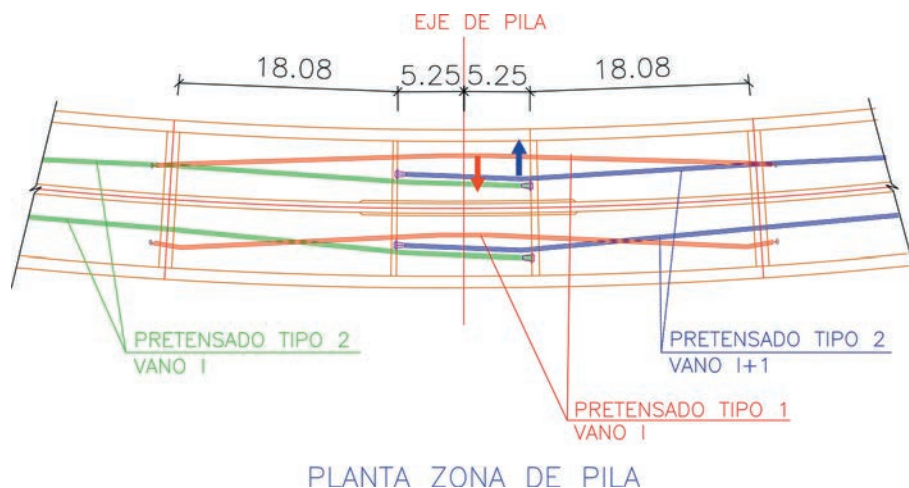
Planta asimétrica del pretensado exterior longitudinal
